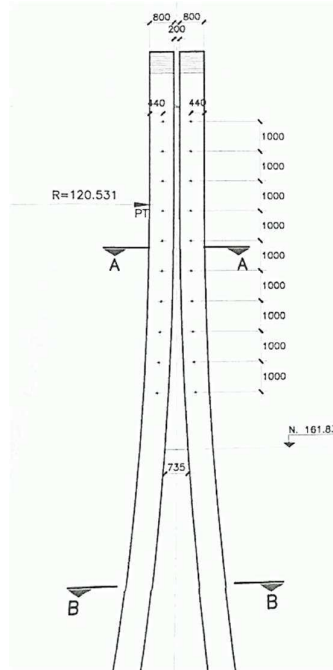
Elevación de torre, espaciamiento vertical de cables.
